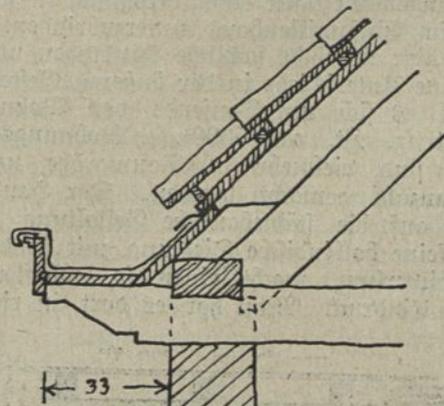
Holländische Dachrinnenkonstruktion, M. 1:20.
